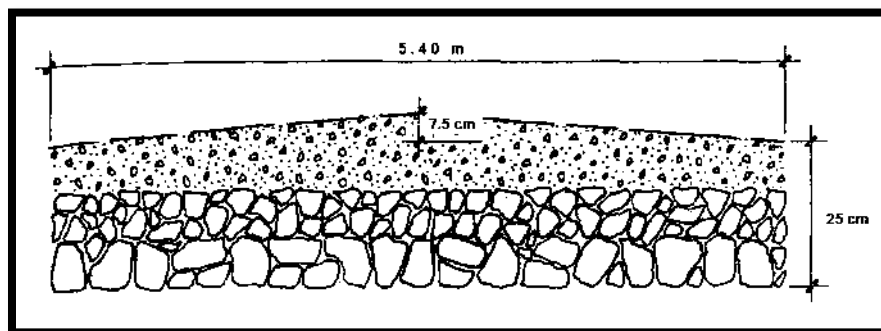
Sección de pavimento desarrollada por Jonh Loudon McAdam, (fuente: Zorio, 1987).
